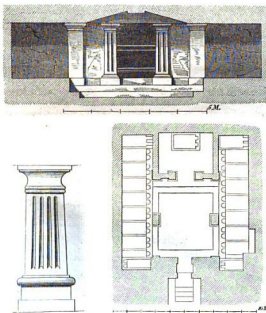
Grundriss, Durchschnitt und Pfeiler der Tomba de' Pilastrini von Cervetri.
